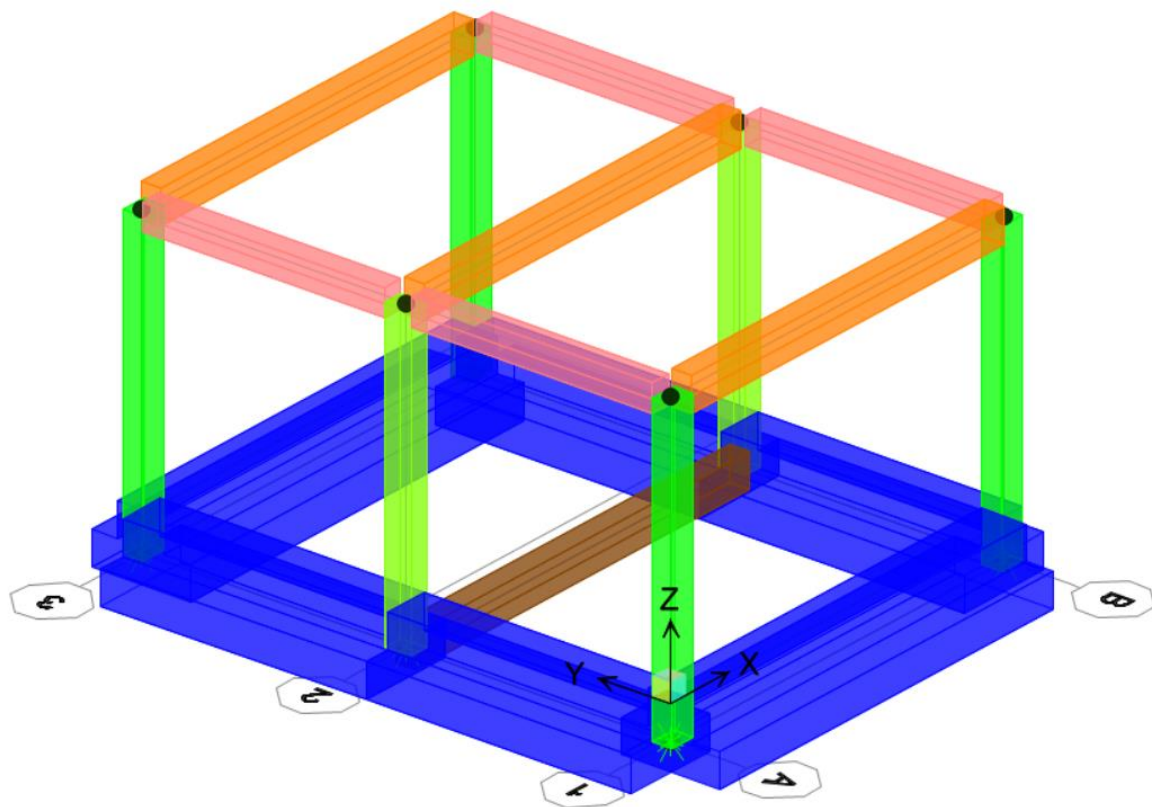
Modello di calcolo, vista assometrica elementi estrusi
